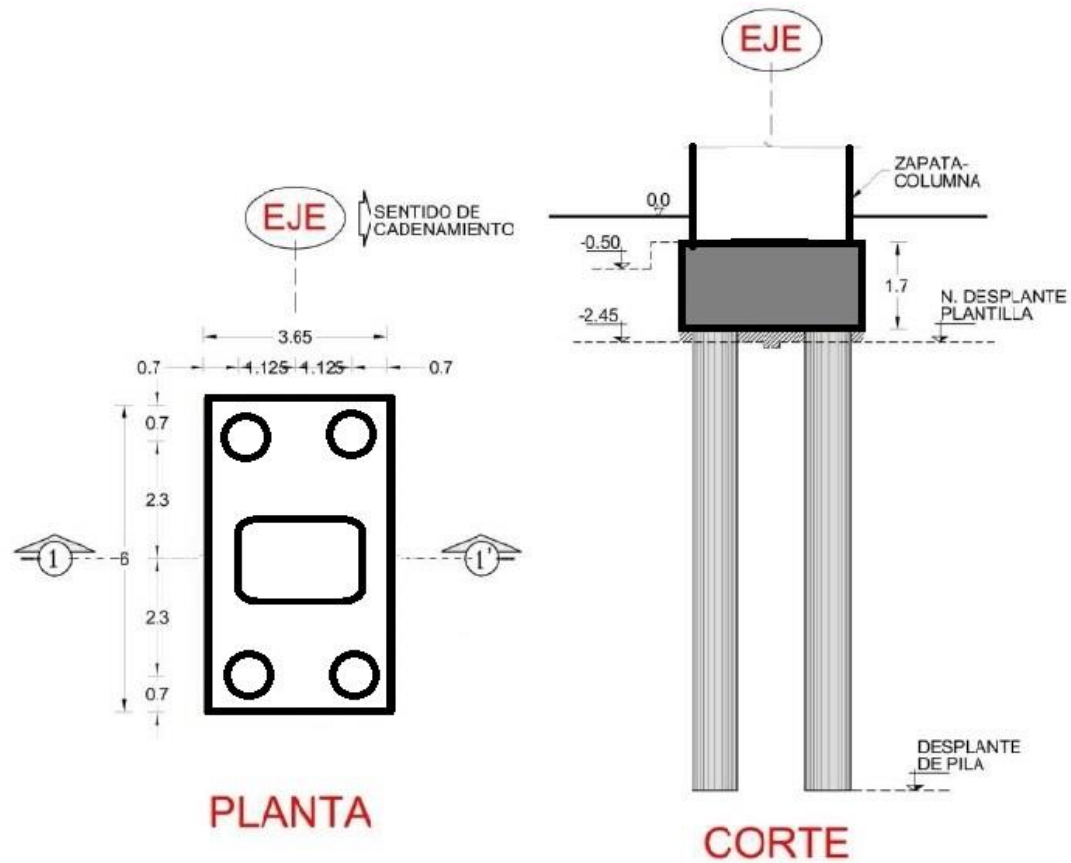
Planta y Corte de Cimentación general de 6 carriles de la AUN.
